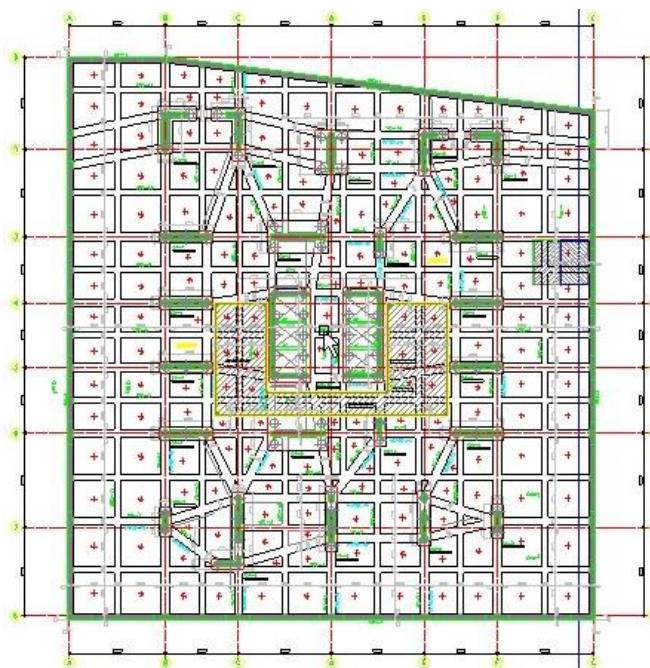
Planta de piso 1 fuente: Diseño estructural Centum
